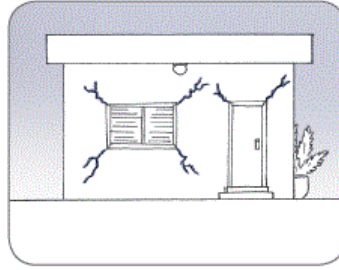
Fissuras nos cantos dos vãos [29]
